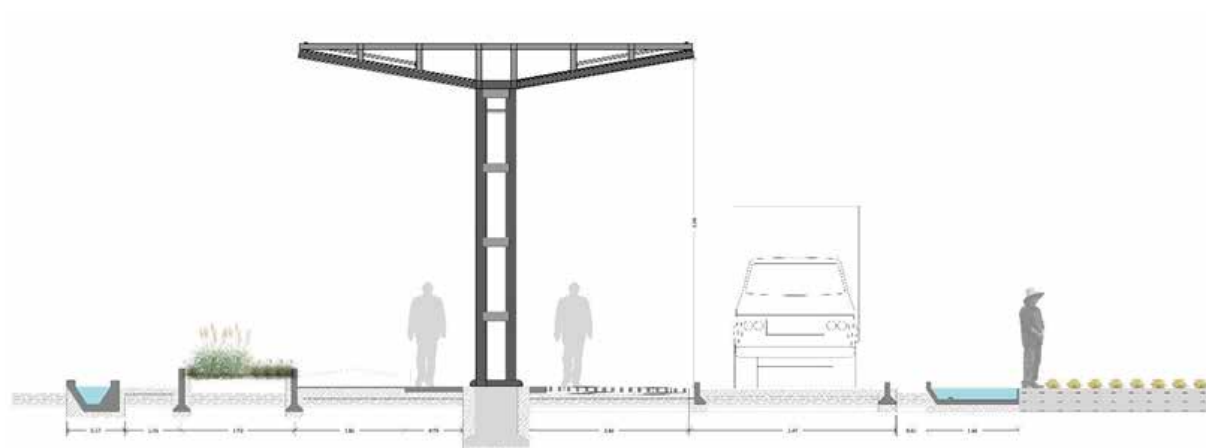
Perfil tipo: paisaje e infraestructura. Fuente: Elaboración propia.
